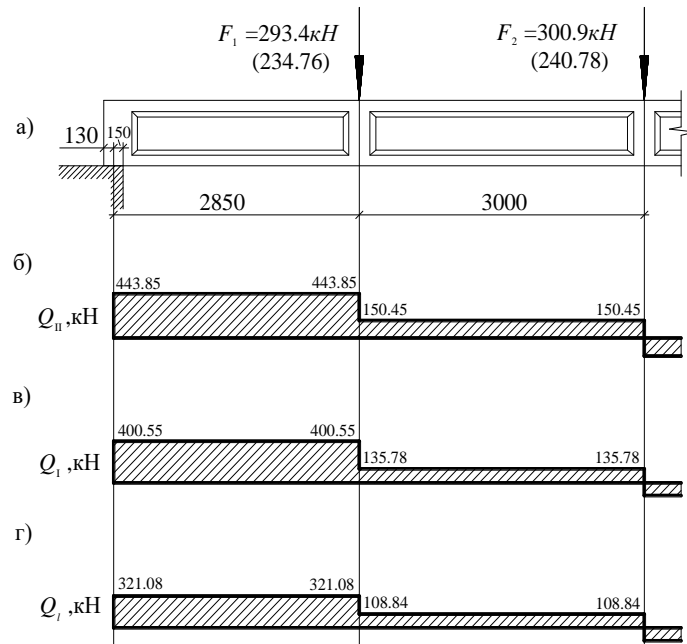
Эпюры поперечных сил подстропильной балки:
